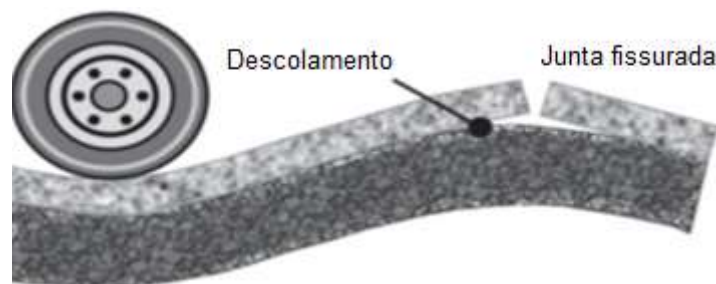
Seção transversal de uma sobreposição de concreto em um estacionamento de pavimento asfáltico
